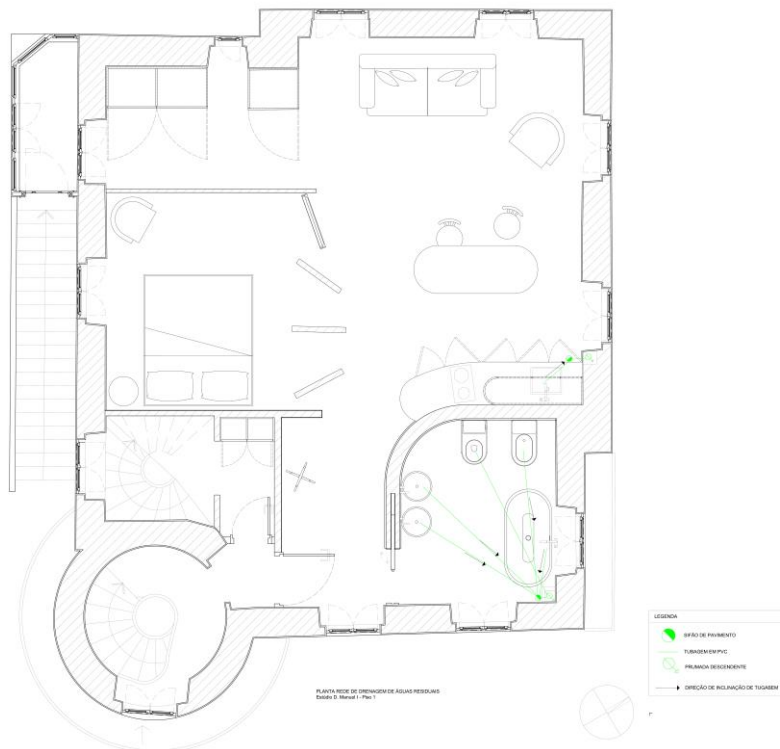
Planta Rede de Drenagem de Águas Residuais- Estúdio D. Manuel I;
